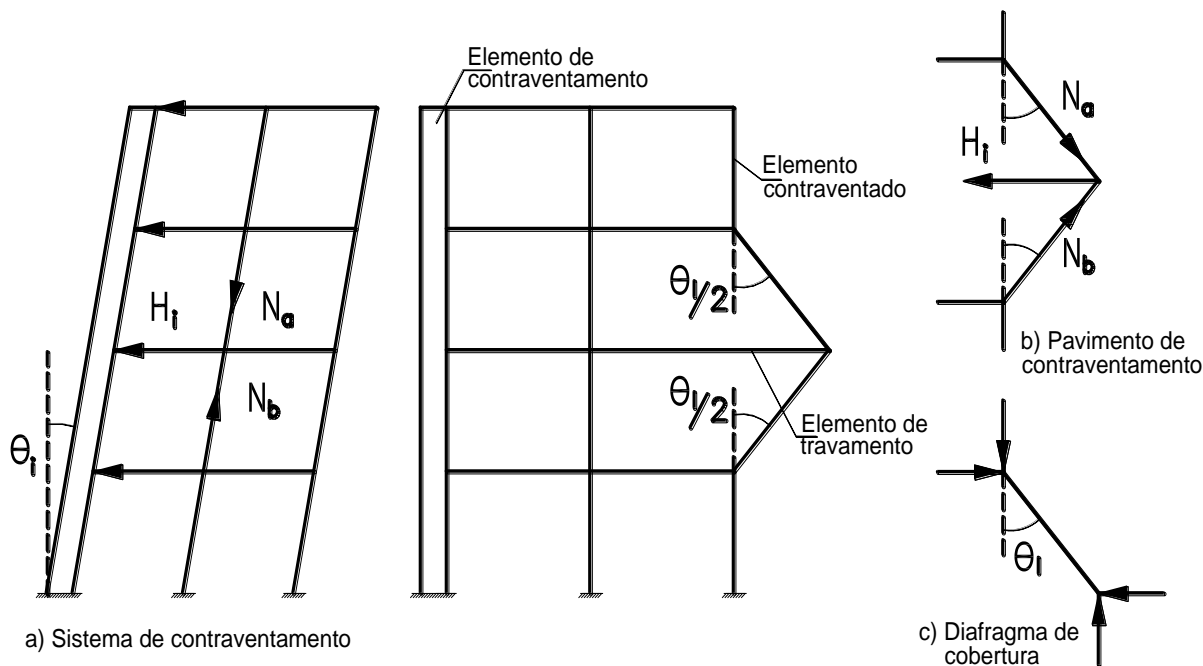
a) Efeito no sistema de contraventamento; b) Efeito no pavimento de contraventamento; c) Diafragma de cobertura
